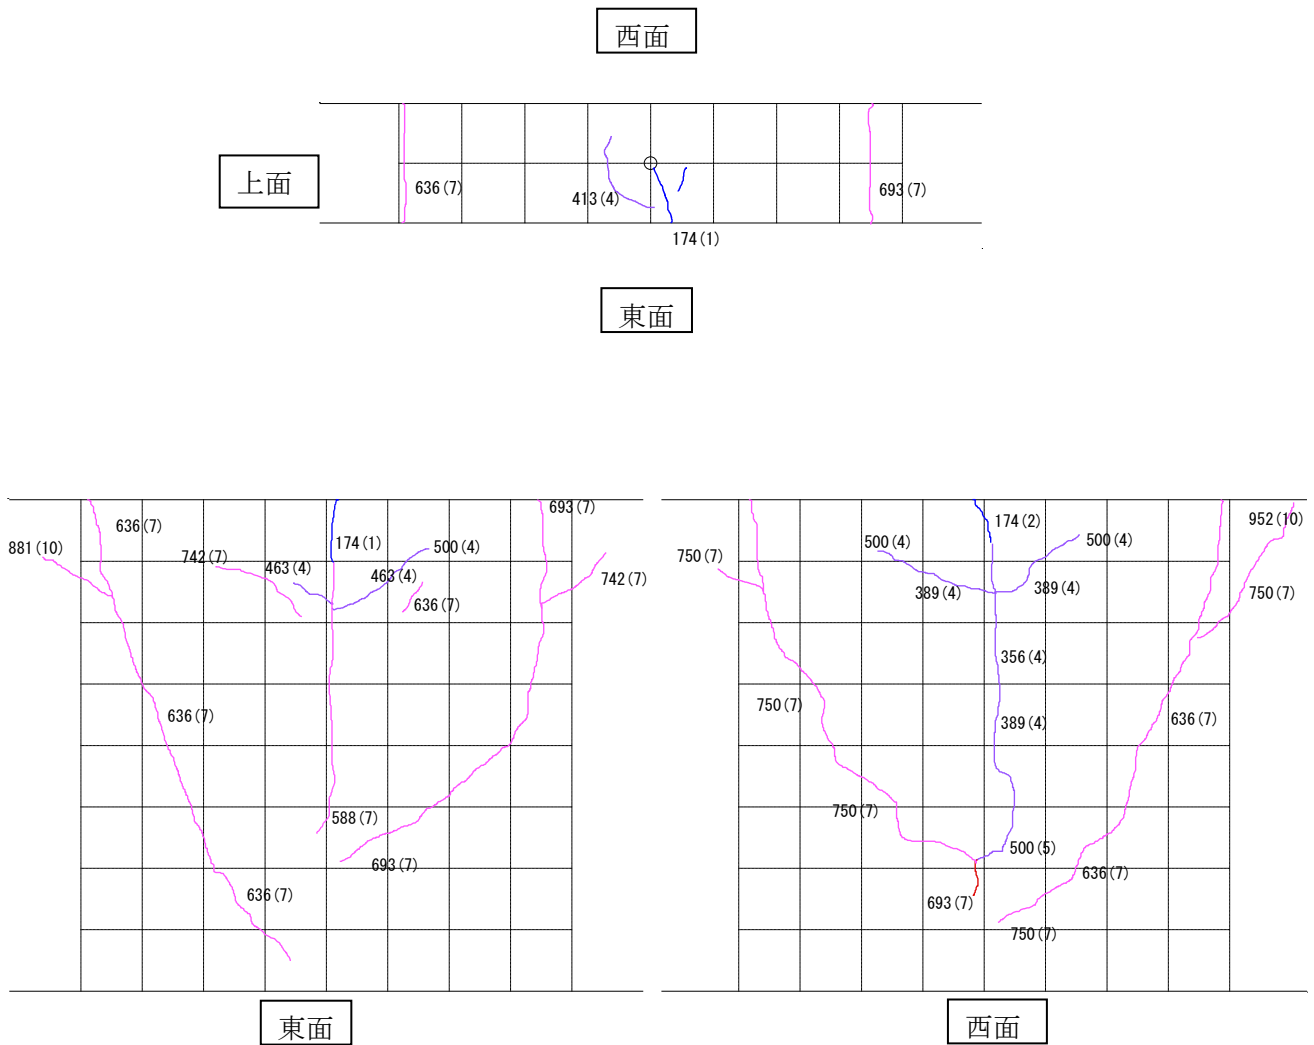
梁幅 180ⅧSD980 試験体のひびわれ状況
